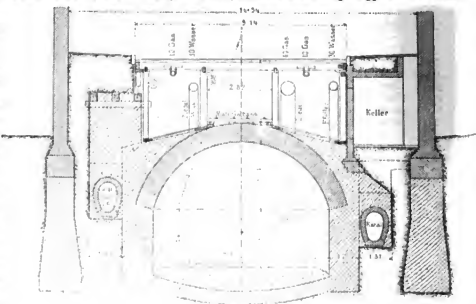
Querschnitt in Cannon Street mit dem fertigen Tunnel.
